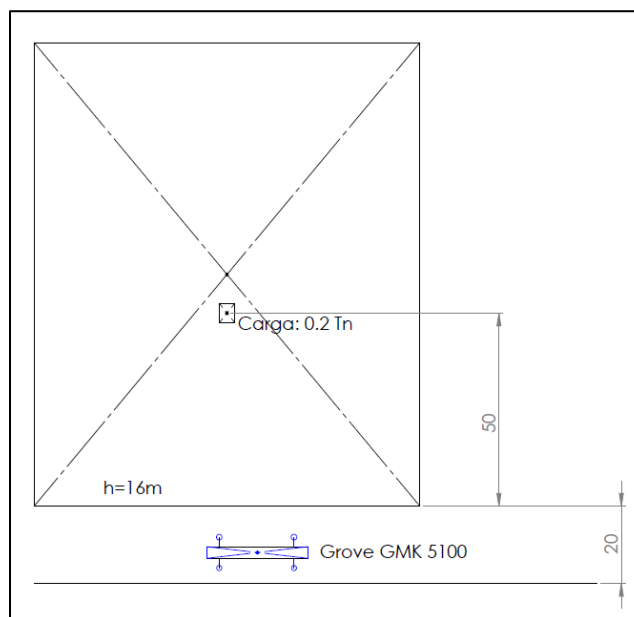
Plano vista superior de área de trabajo-Fuente: Autor
